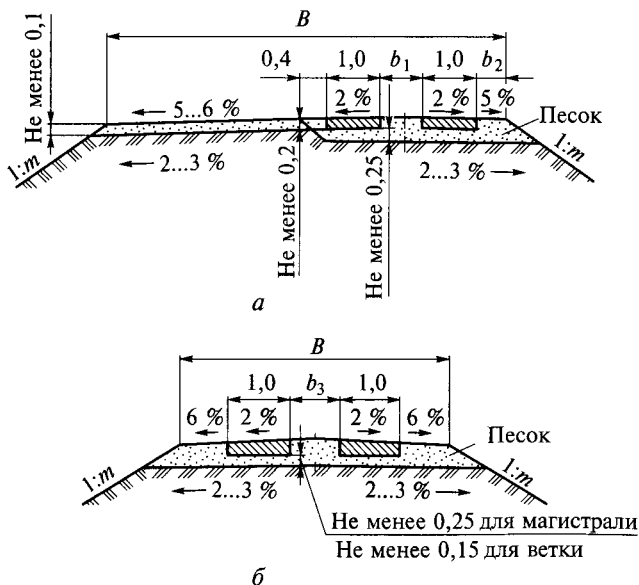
Поперечные профили колеиных дорожных одежд с покрытиями из железобетонных плит (все размеры указаны в метрах):
